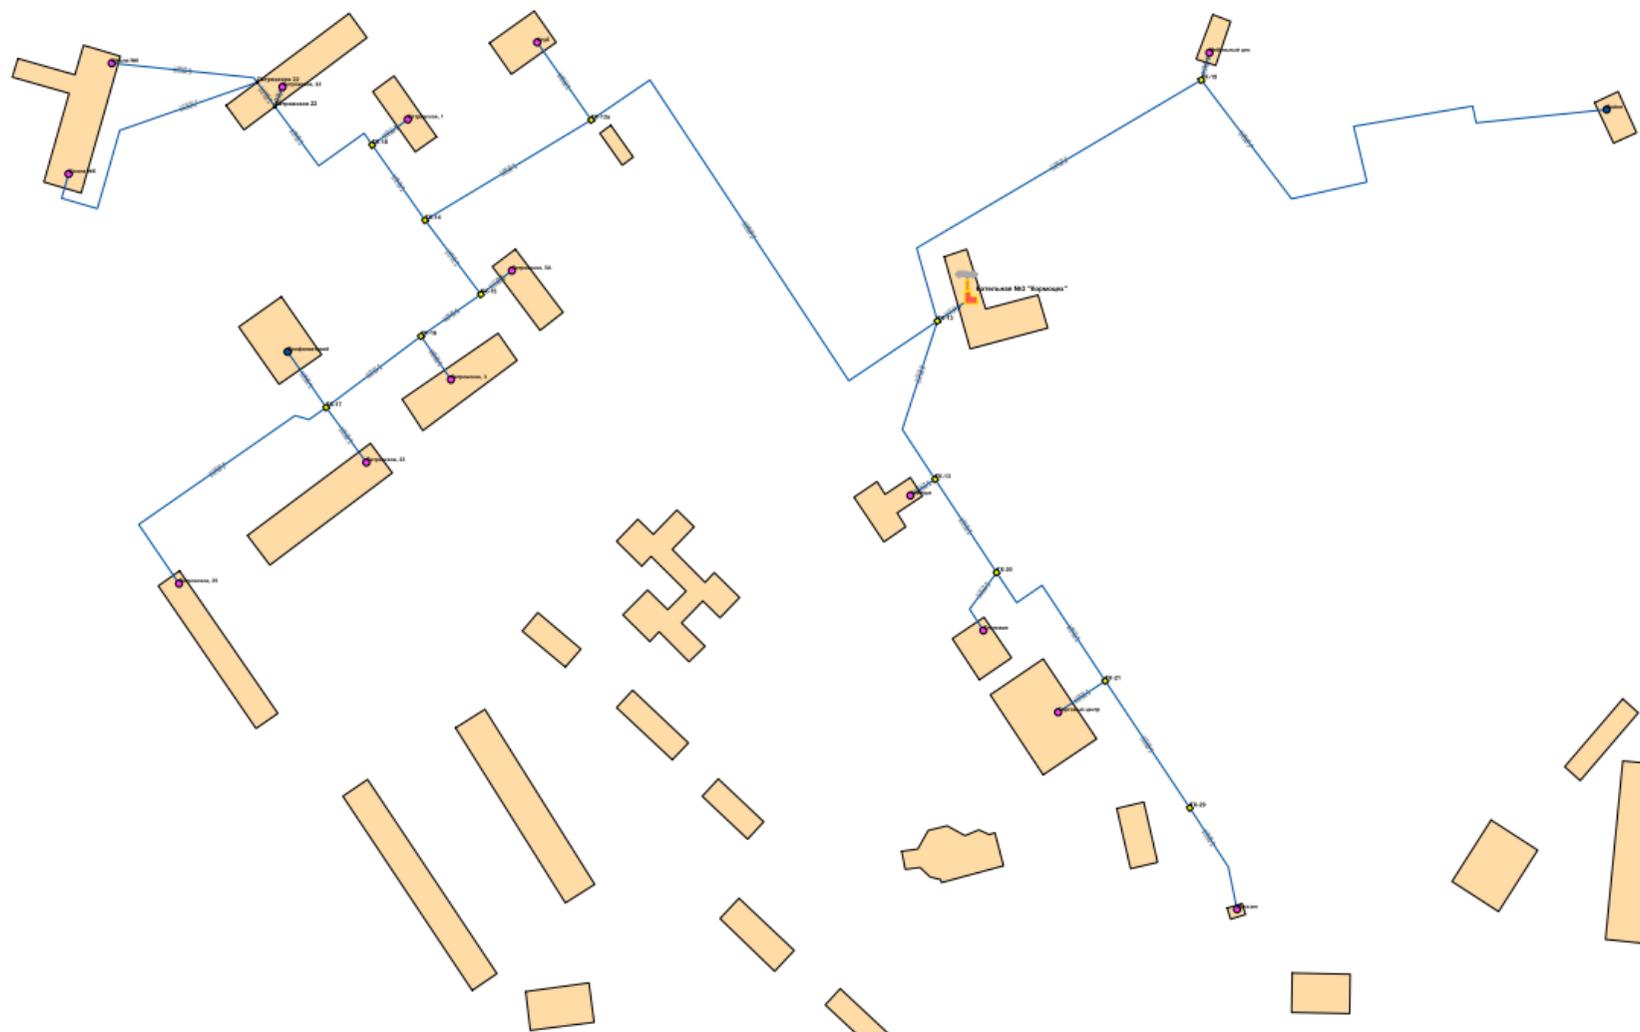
Схема тепловых сетей котельной №3
